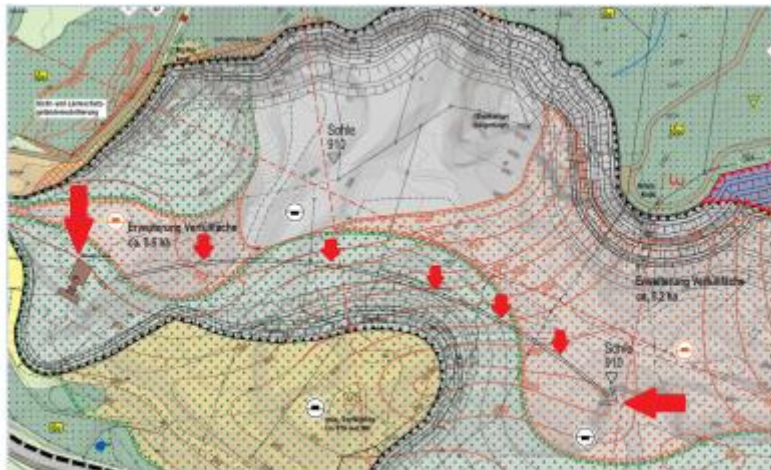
Geplante Verlagerung Klassieranlage – Quelle: 1. Änderung Bebauungsplan
